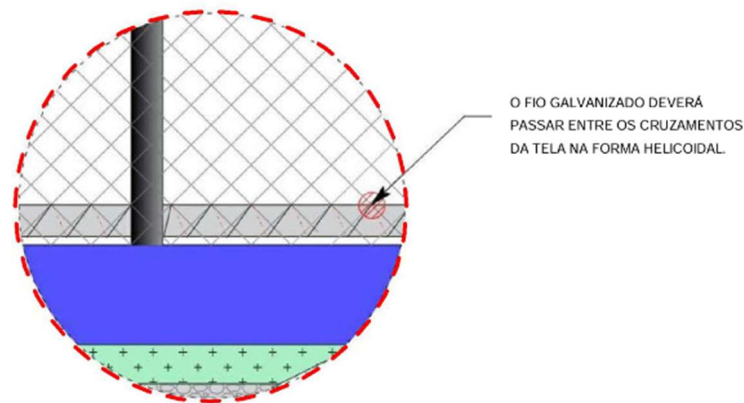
Detalhe da fixação das telas (Fonte: Autor/2025)
